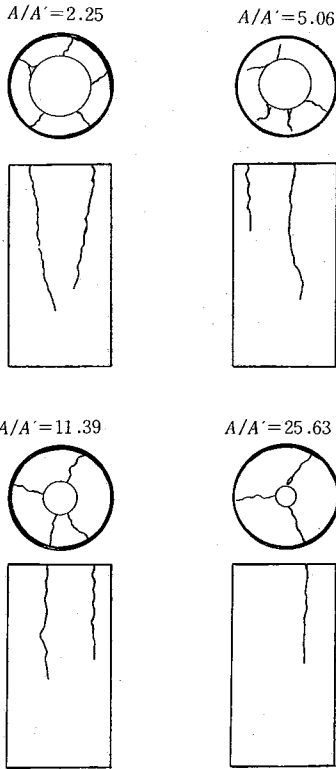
ひびわれ状況 (プレーンコンクリート)
